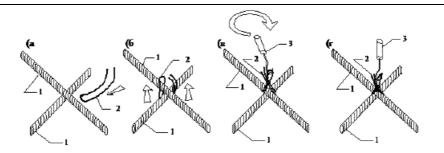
Схема фиксации арматурных стержней вязальной проволокой:
